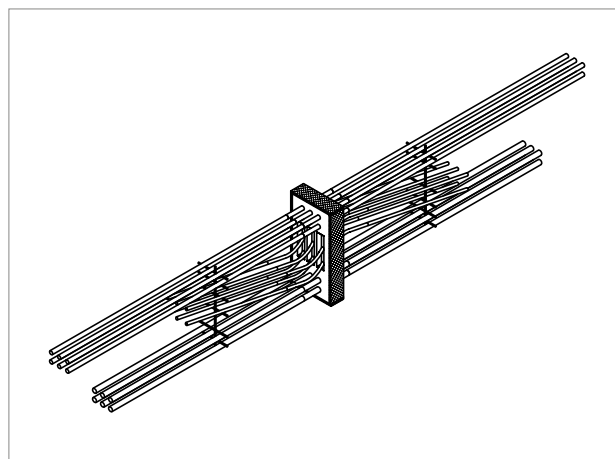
Schöck Isokorb® T Type B : Panneaux de protection incendie sur tout le pourtour
